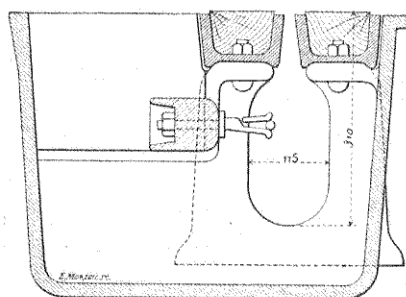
Coupe du caniveau actuel de Blackpool.
